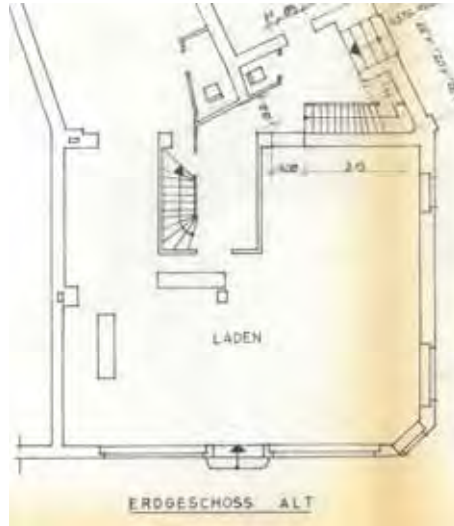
Grundrisskizze zur Umnutzung des Ladenlokals Marktstraße 7 zu einer Wohnung
